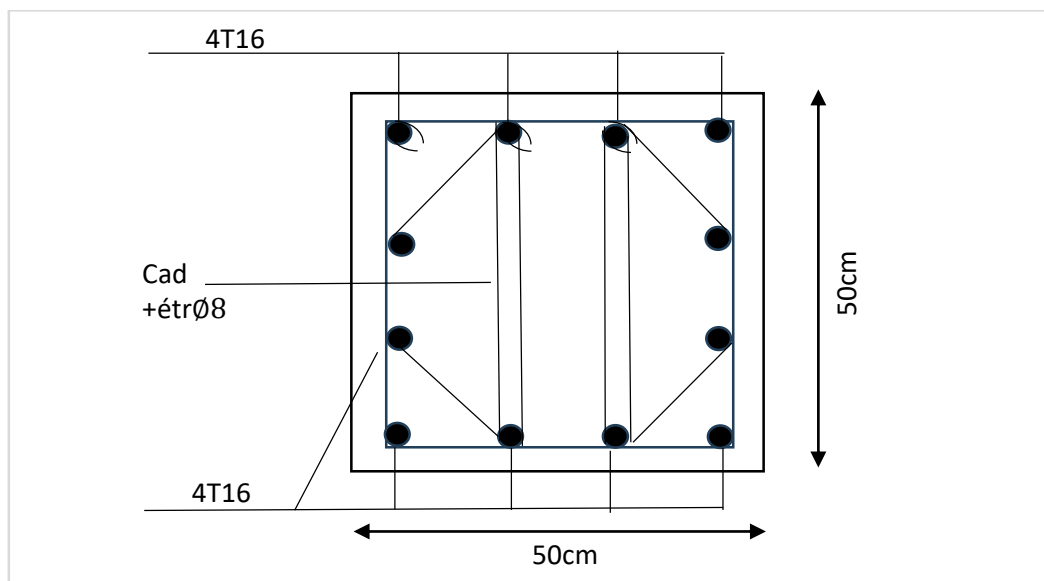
Ferrailage des poteaux de RDC (50*50)
